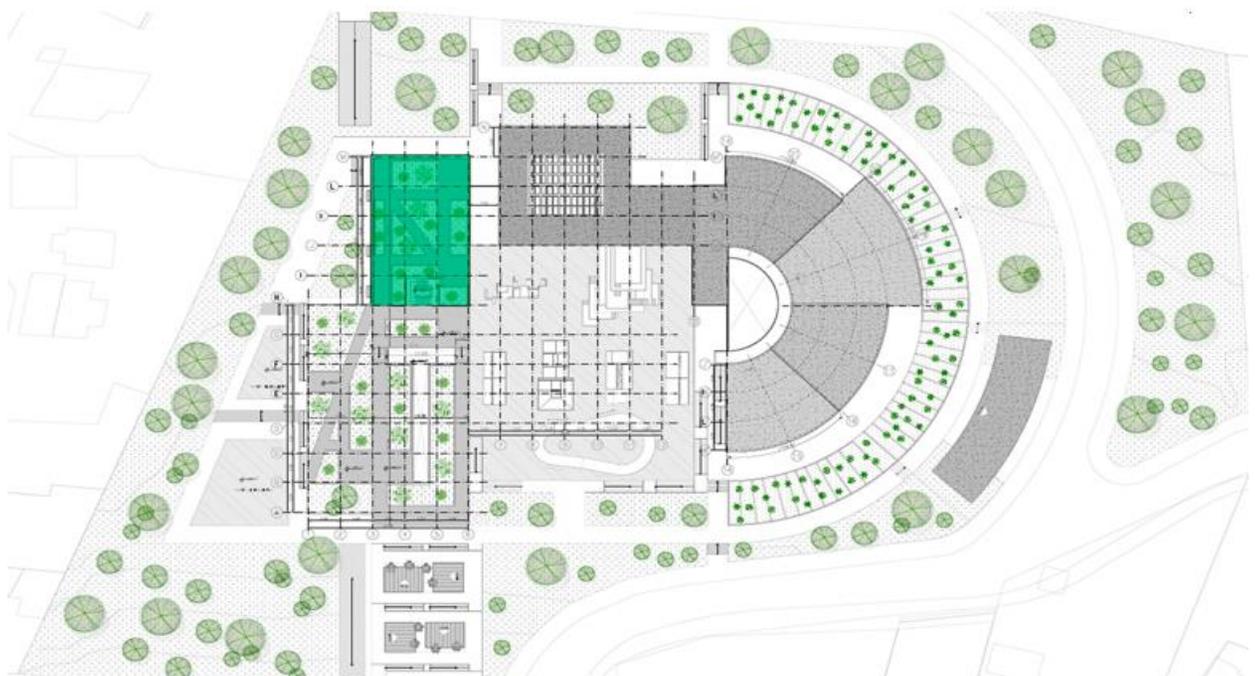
Zonificación Planta 2. Fuente: Elaboración propia.
